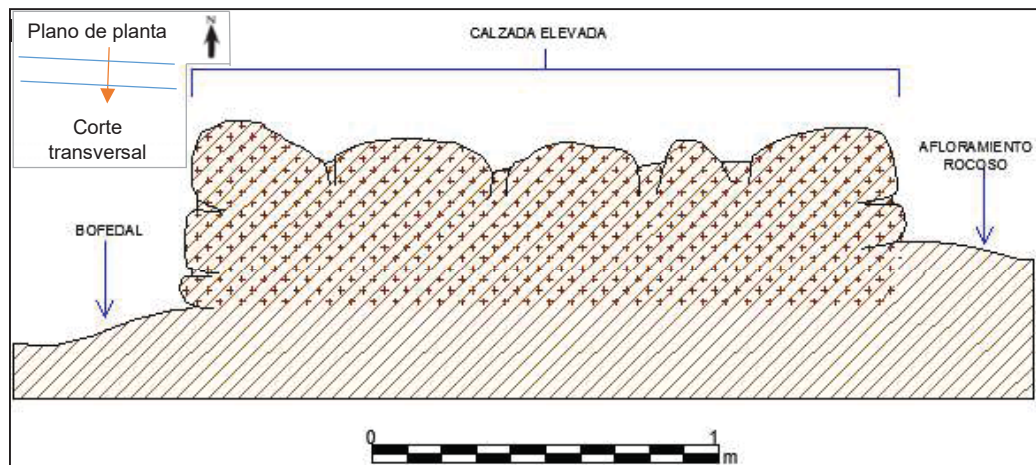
Dibujo de corte transversal de camino ritual calzada elevada (Fig. 79).
